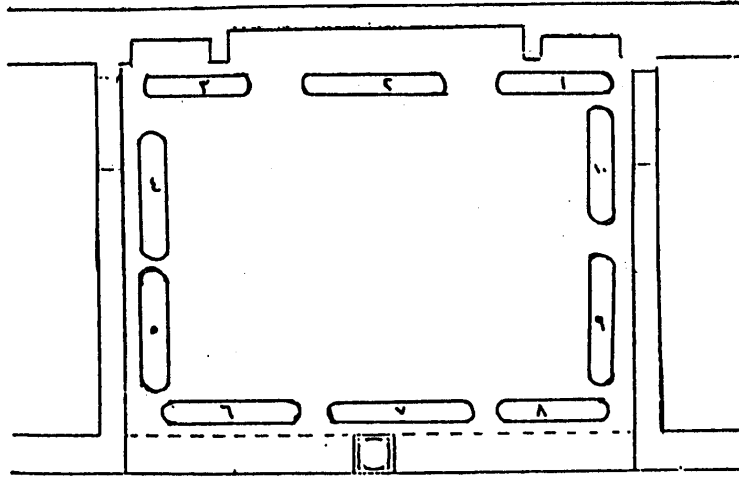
مسقط أفقي للمقعد والمبيت بمنزل الست وسيلة .
